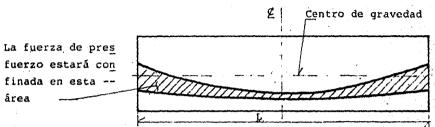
Diagrama que ilustra el área en donde la fuerza de presfuerzo deberá estar confinada con objeto de sa tisfacer los requerimientos de esfuerzos iniciales y finales admisibles.
